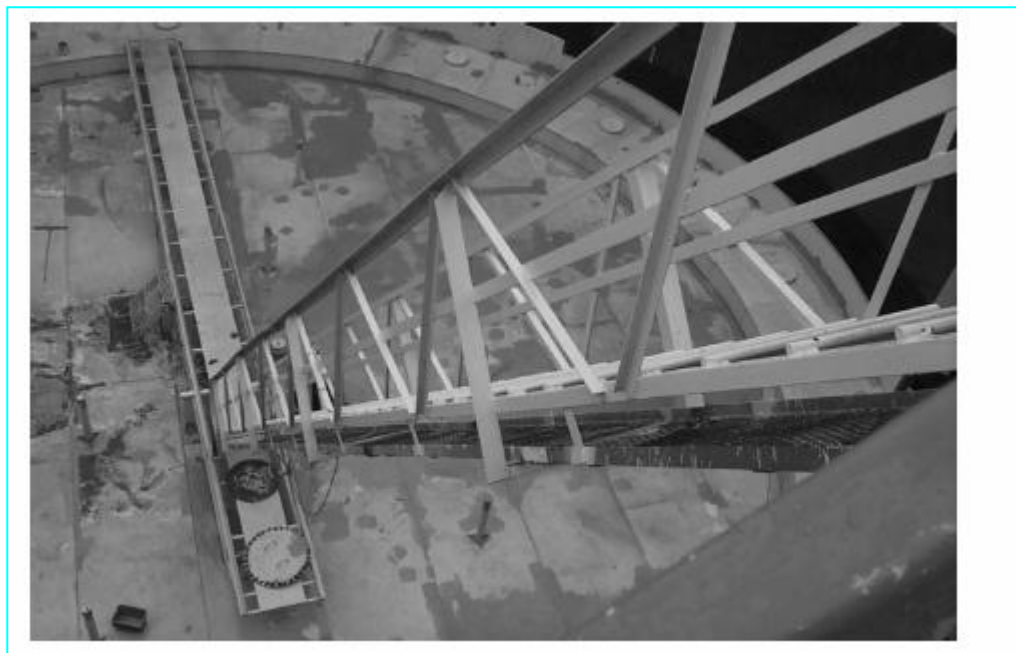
Echelle-escalier installé sur un toit flottant
